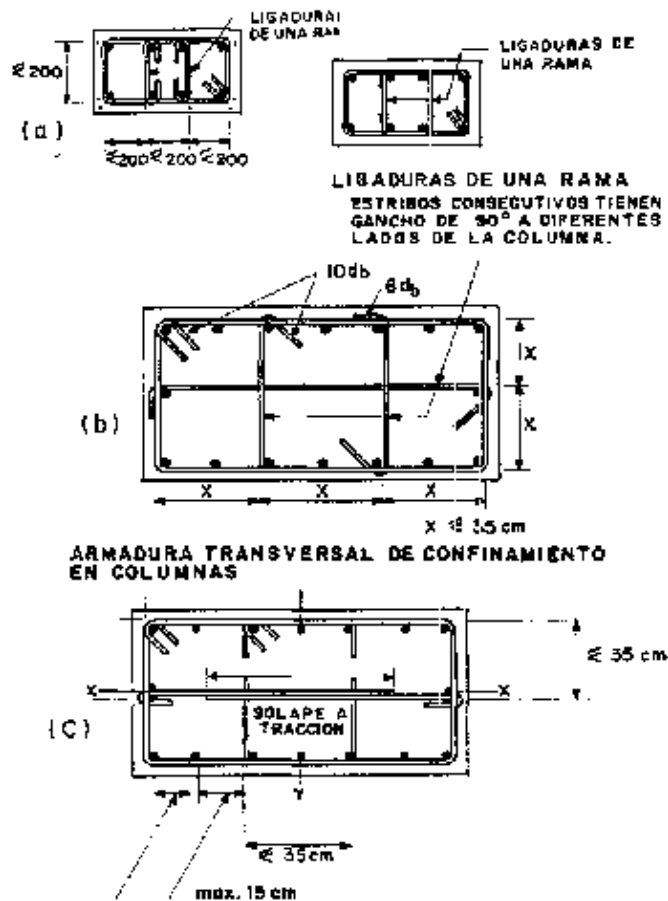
Ligaduras de una rama para refuerzo transversal en columnas.
